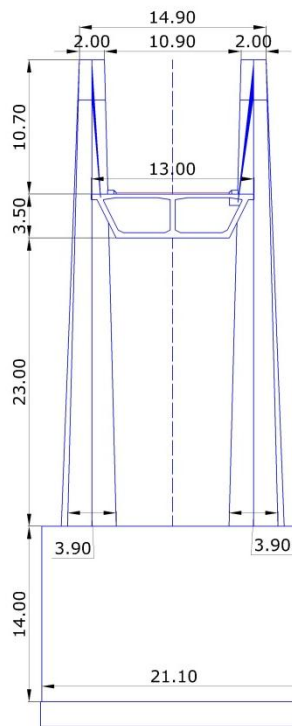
Alzado transversal de la pila-torre con la sección del tablero
